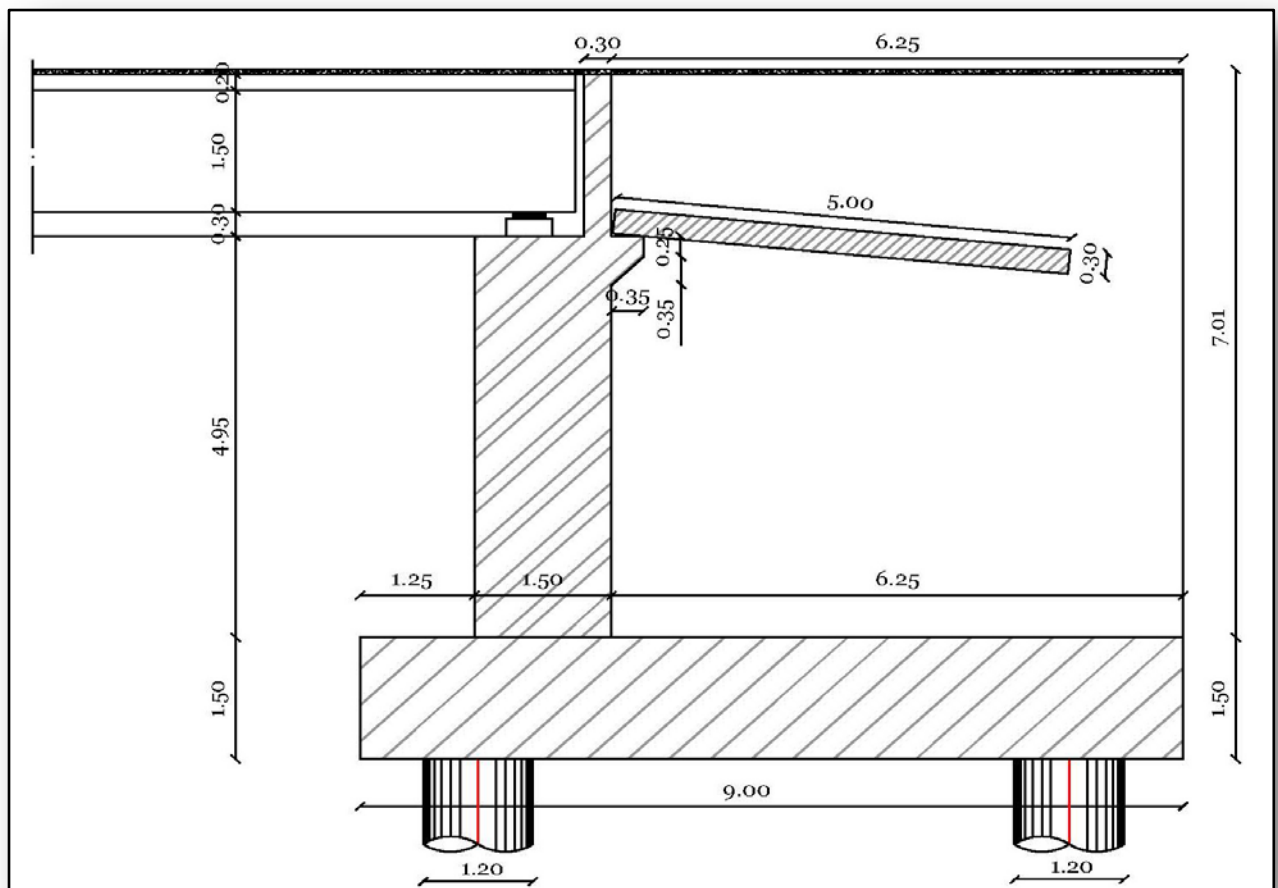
Coupe en élévation de l'ouvrage.
